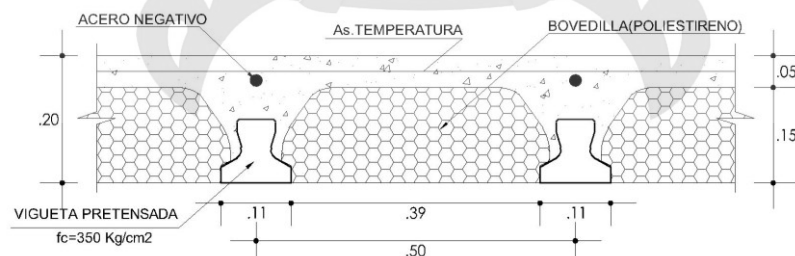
Detalle de losa compuesta con vigueta pretensada.
